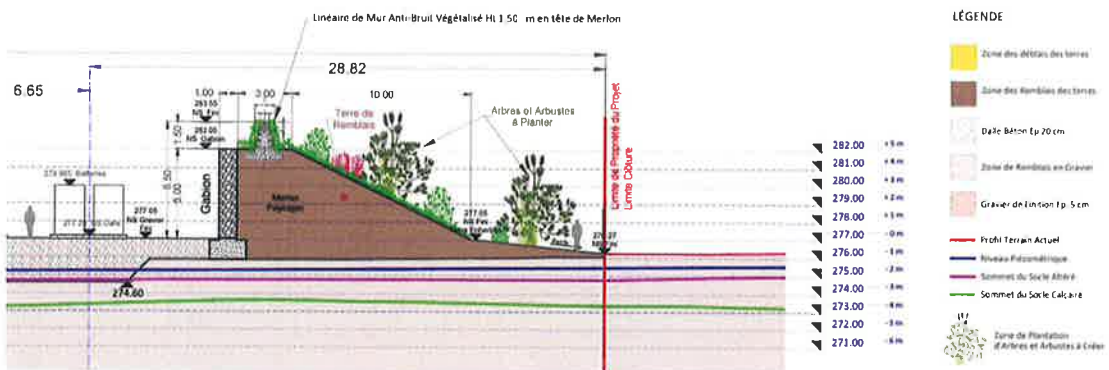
Détail du merlon dans la version dossier plans modificatifs (15/7/2024)
